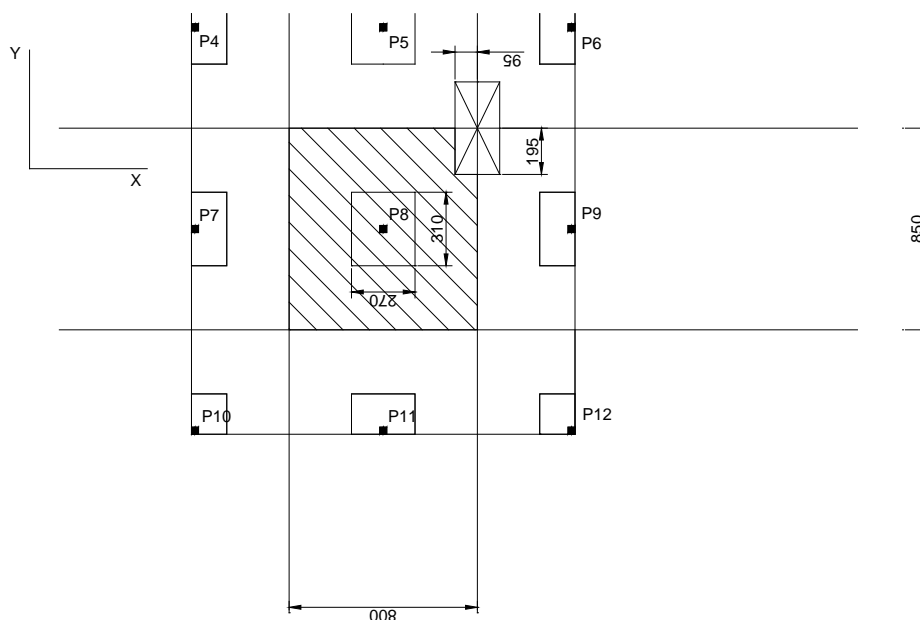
ÁREA DE INFLUÊNCIA DA LAJE PARA O PILAR P8
